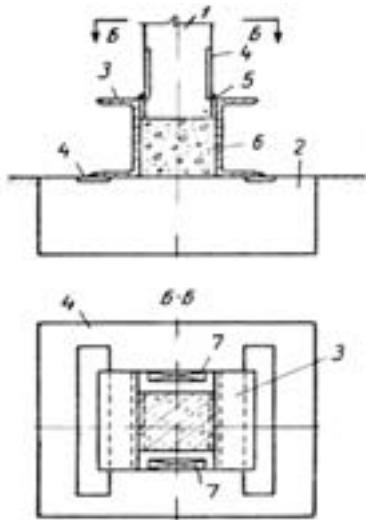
Вузол з'єднання залізобетонної стійки підсилення з плоским фундаментом;
